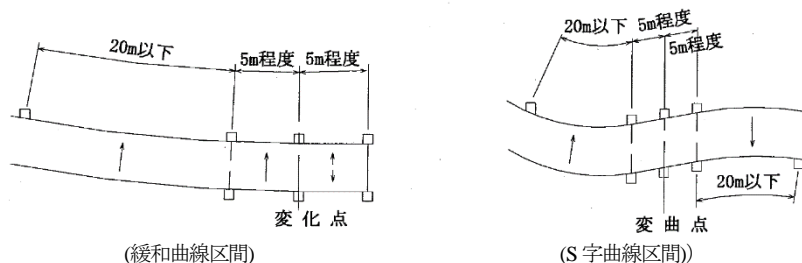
変曲点付近の排水柵の設置方法(平面図)
